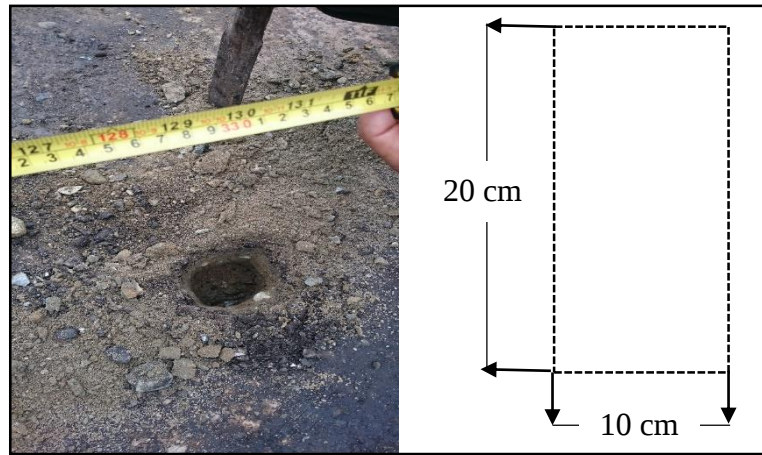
Dimensión del agujero en el punto N° 1; Taller A
